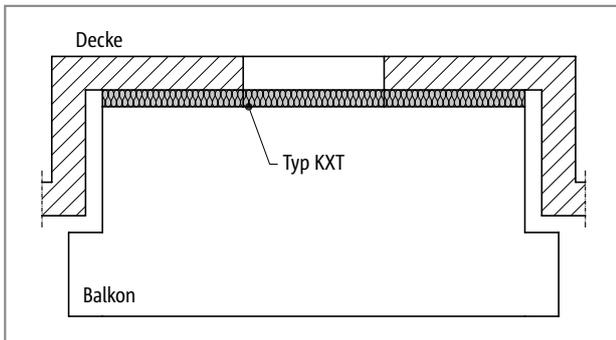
Schöck Isokorb® Typ KXT: Balkon bei Fassadenrücksprung
